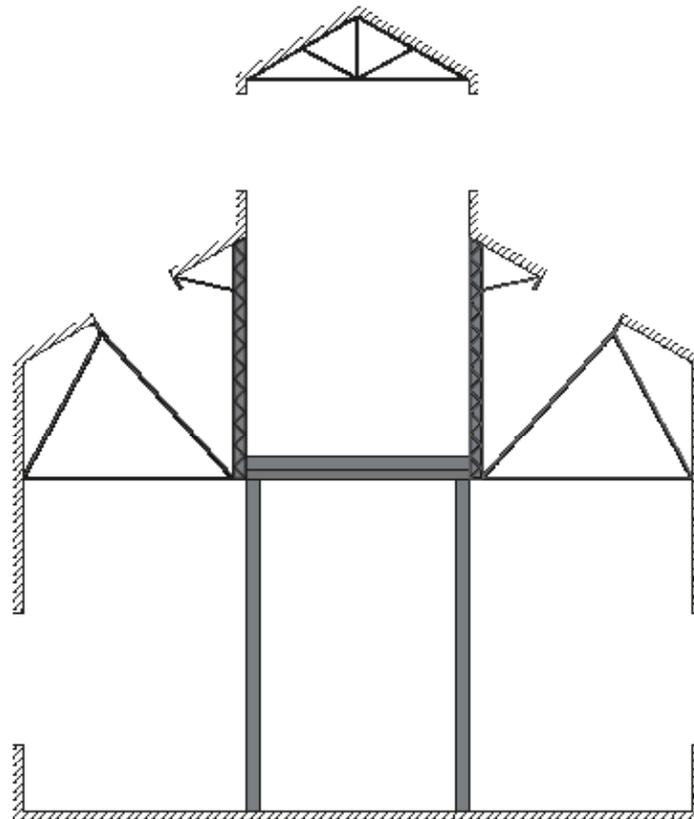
Desenho do corte que dá origem ao módulo para construção do elemento cénico
